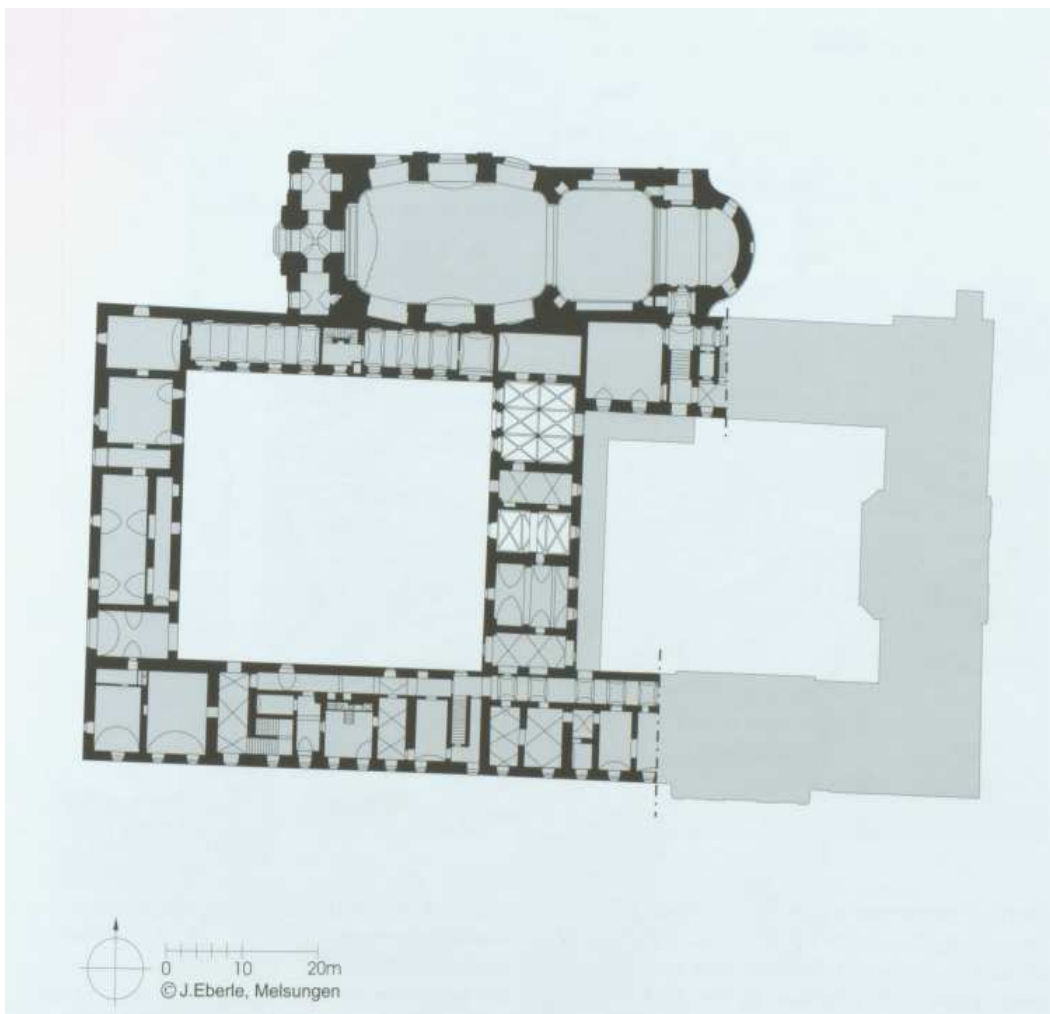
Stift Engelszell, Grundriss, Jürgen Eberle
